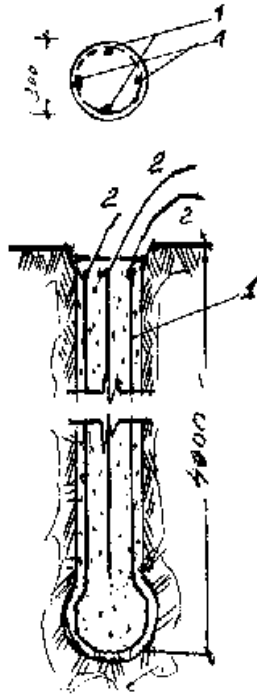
Пример прогрева буронабивных свай греющим проводом:
